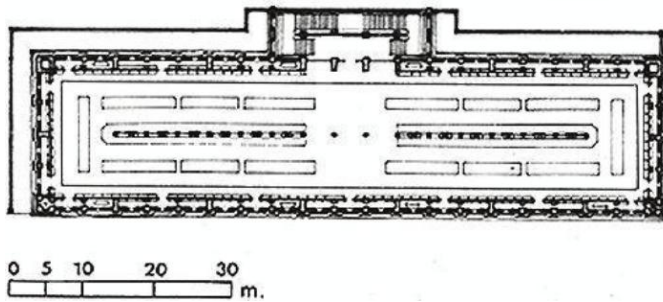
Planta da Biblioteca de Santa Genevieve
